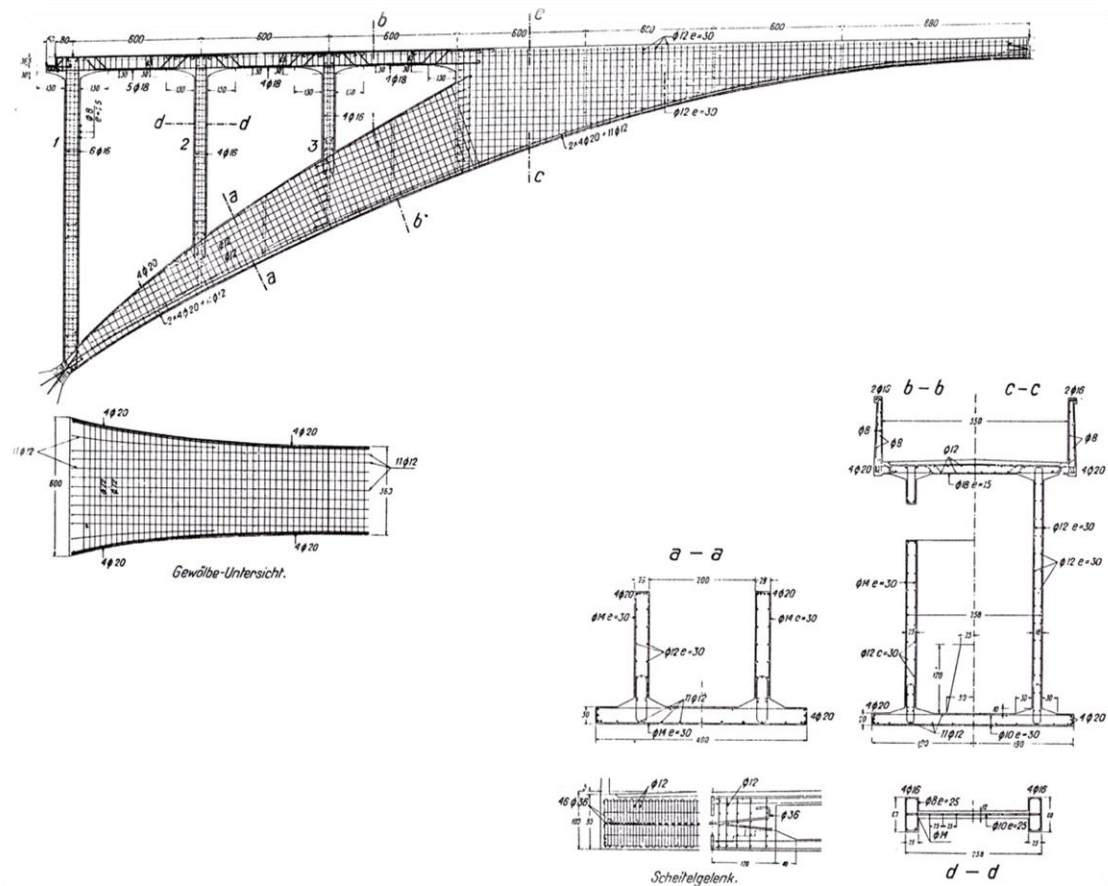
Puente Salginatobel en Schiers, Suiza. Robert Maillart. 1930. Despiece de armaduras y detalle de las distintas secciones de hormigón. Planos. Bibliothek-ETH, Zürich.
